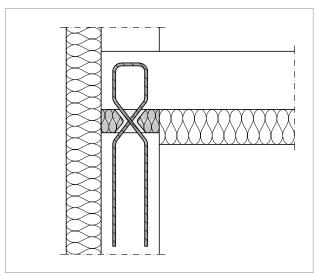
Schöck Sconnex® type W-N-VH : mur extérieur ; isolation sous la dalle selon la coupe B-B
